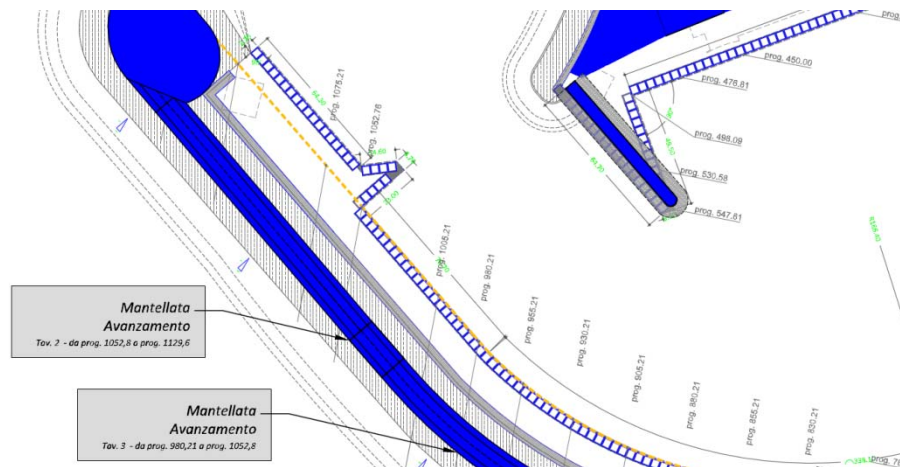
porzione di molo di sopraflutto oggetto di lavoro nel semestre 10/2014 – 03/2015
